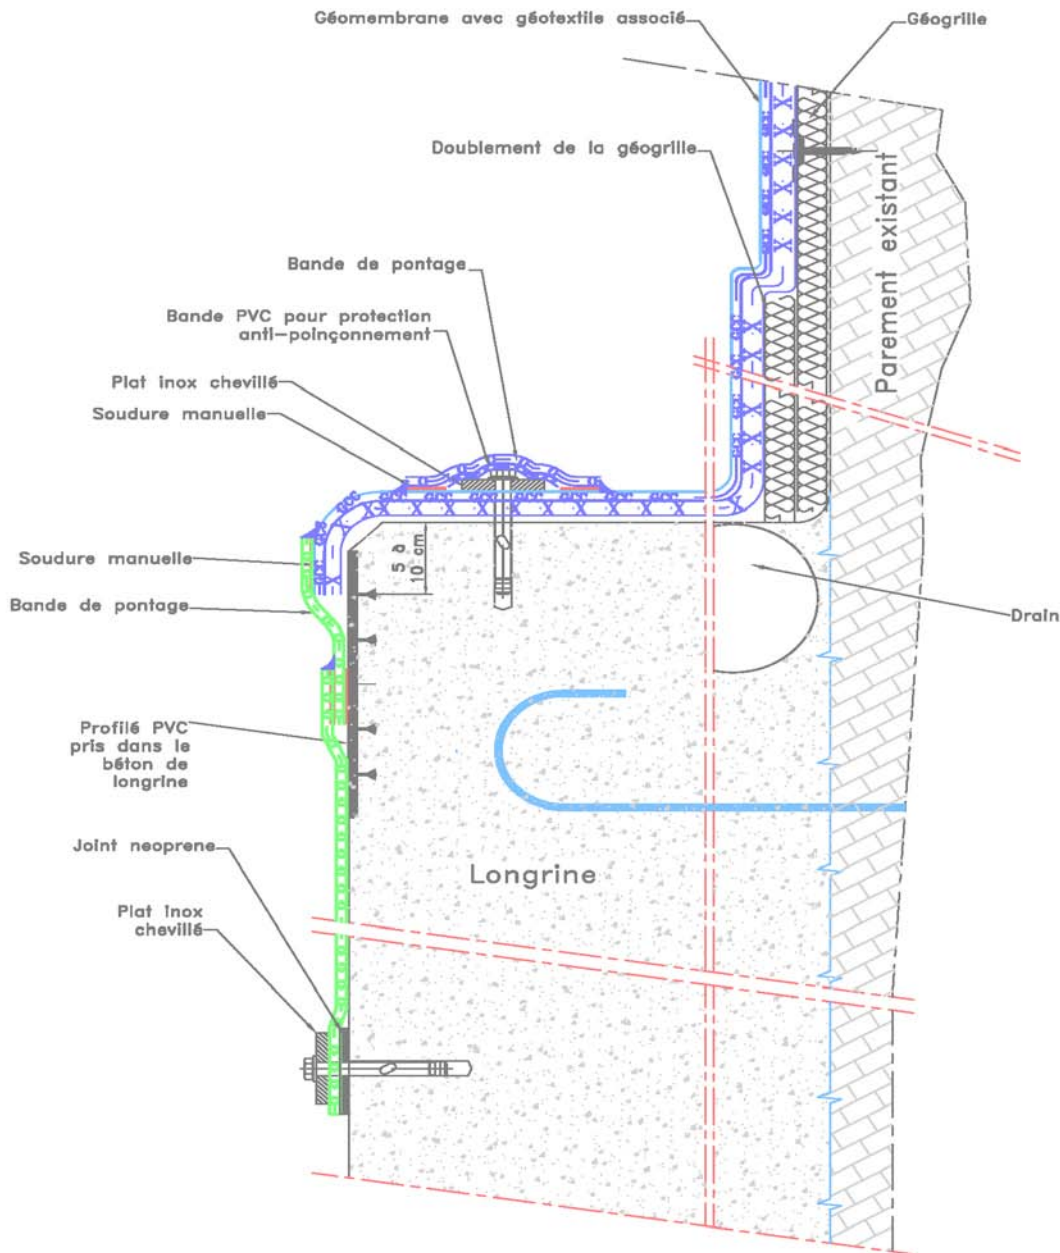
Etanchéité du Barrage de la Muratte, principe d'arrêt en pied
